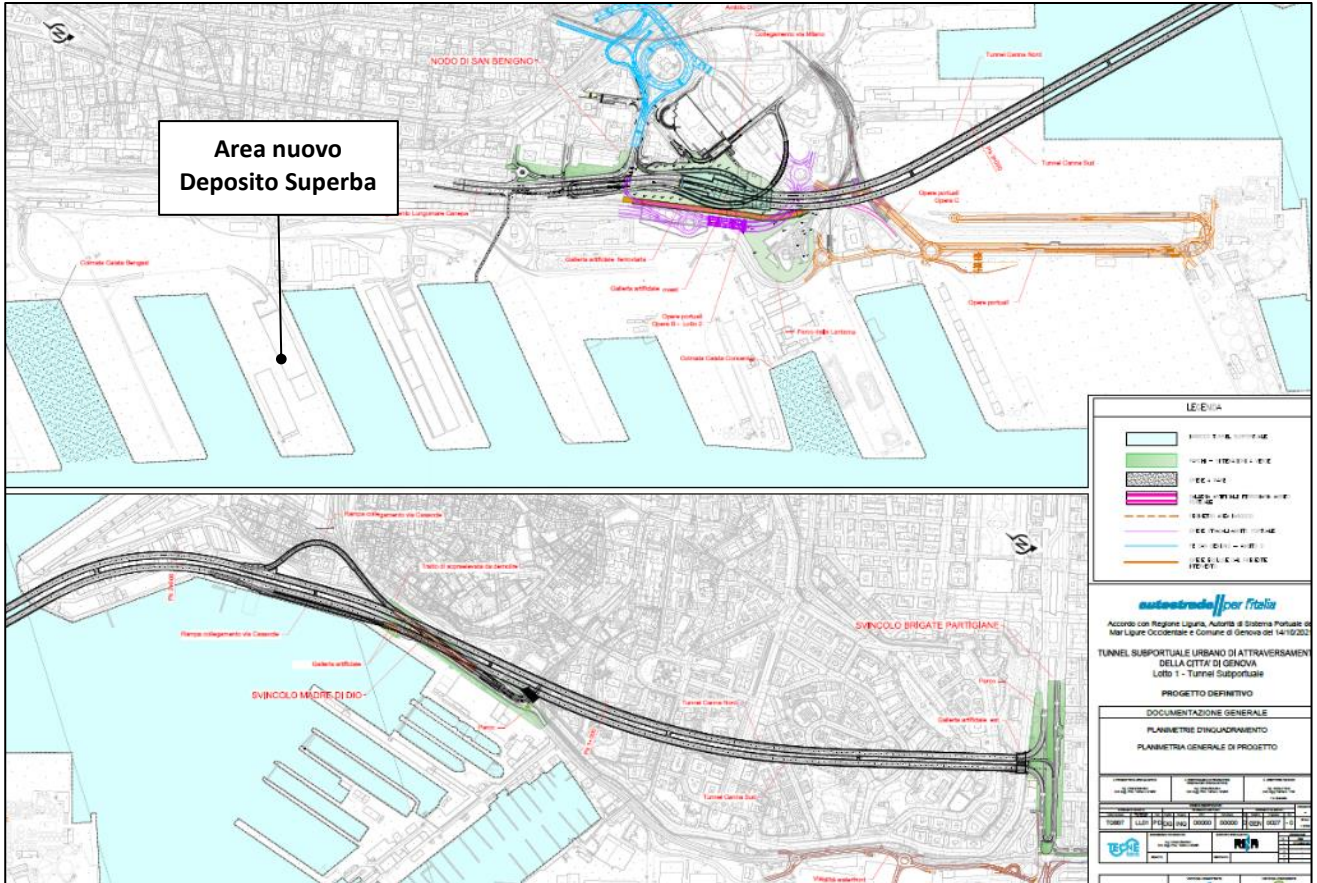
Estratto Planimetria generale di progetto del tunnel sub-portuale
